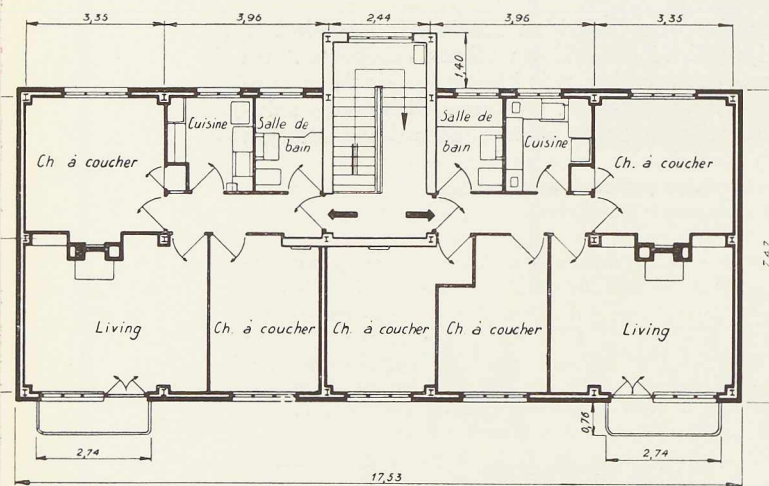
Plan du 1^{er} étage. On note la disposition standard des cuisines et salles de bain aux deux étages.
